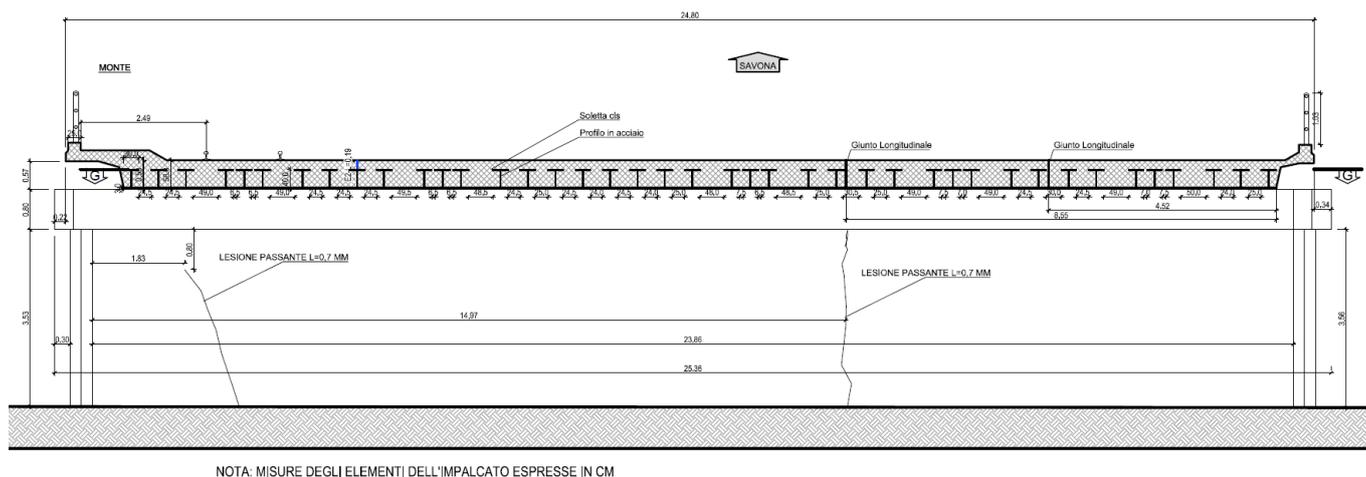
Sezione trasversale del ponte di via Ferraris
